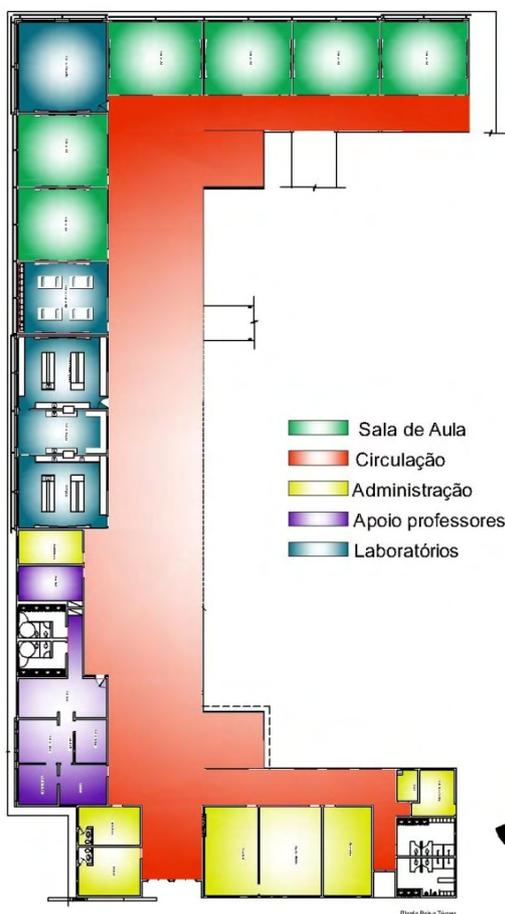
Planta Baixa Térreo, Bloco das salas de aula
